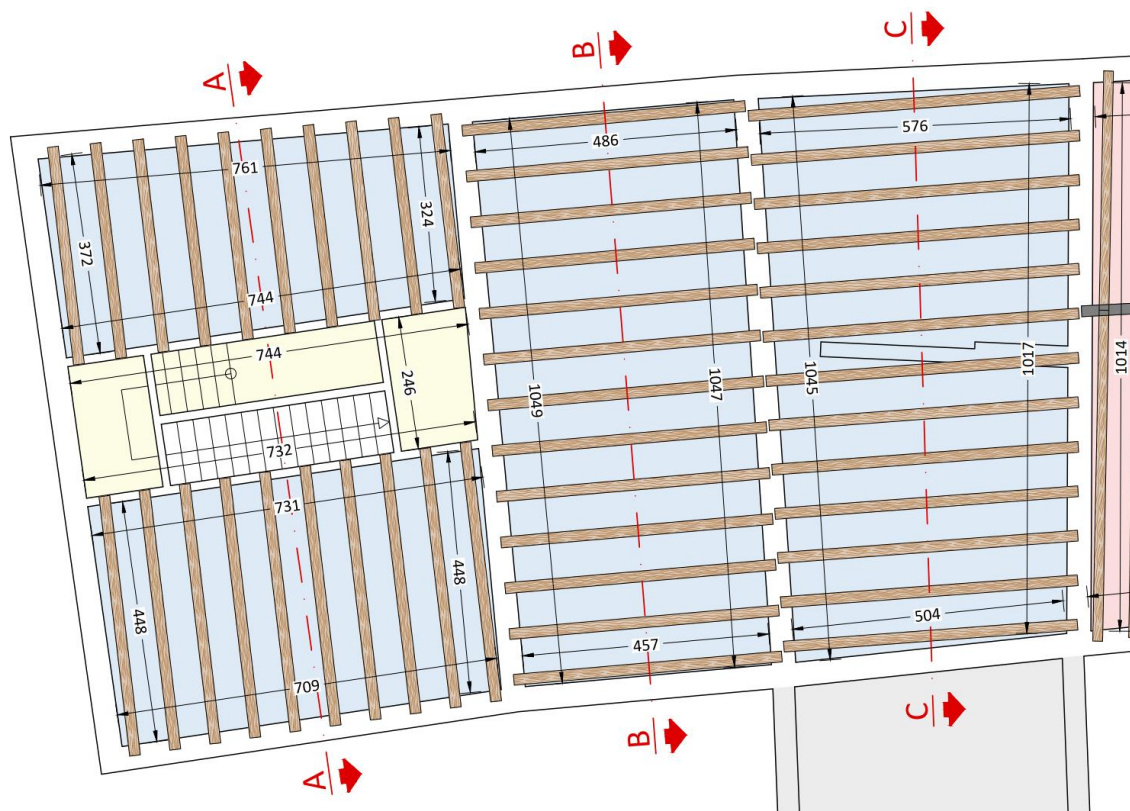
Pianta solaio piano terra dei blocchi A,B,C
